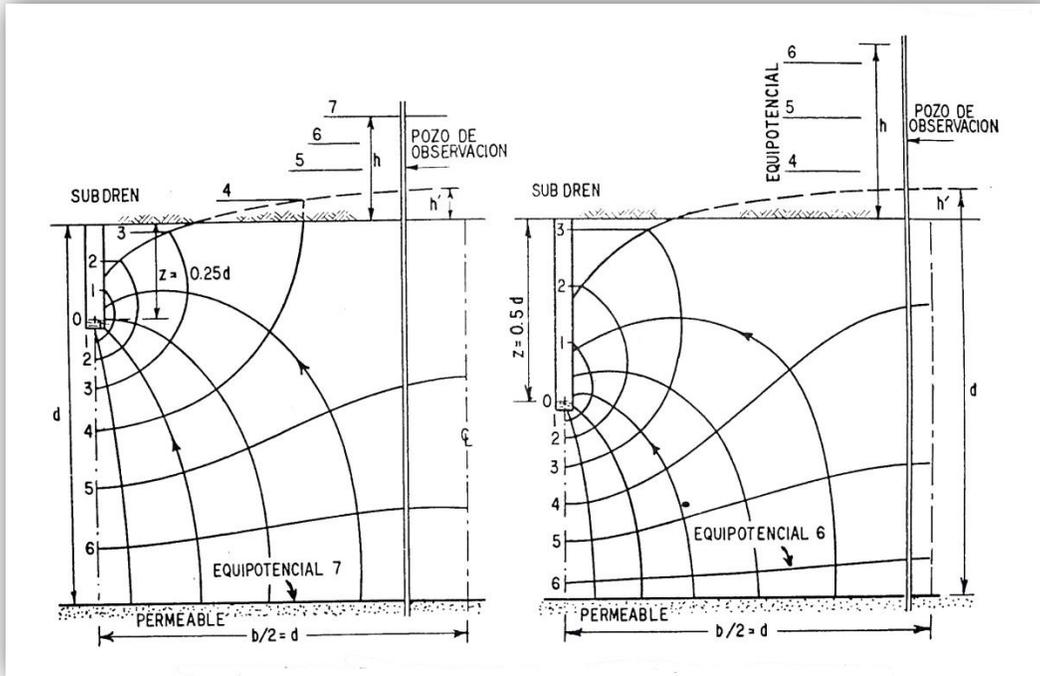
Redes de flujo típicas hacia drenes longitudinales de zanja (ref. 18).
